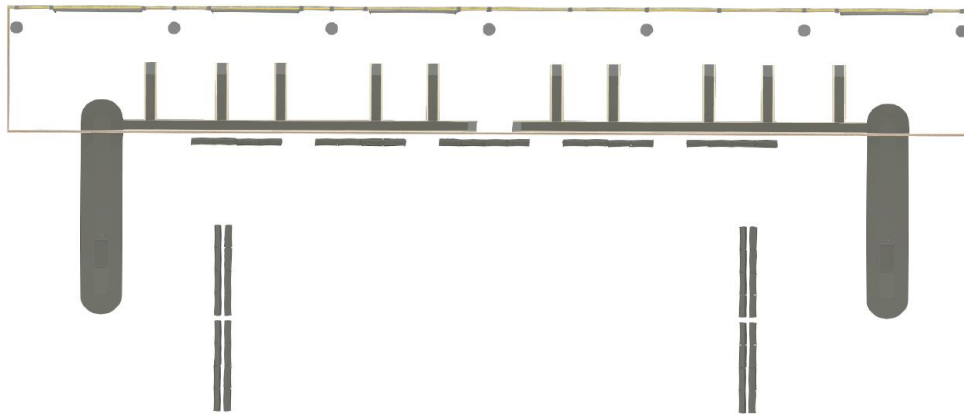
Vista de planta de la zona de tratamiento de equipaje del vestíbulo inferior de llegadas.
